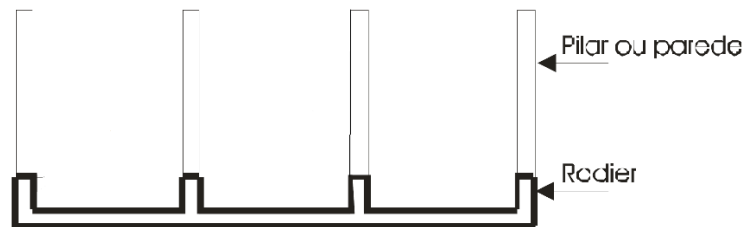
Radier nervurado – Fonte: Dória, (2007).
